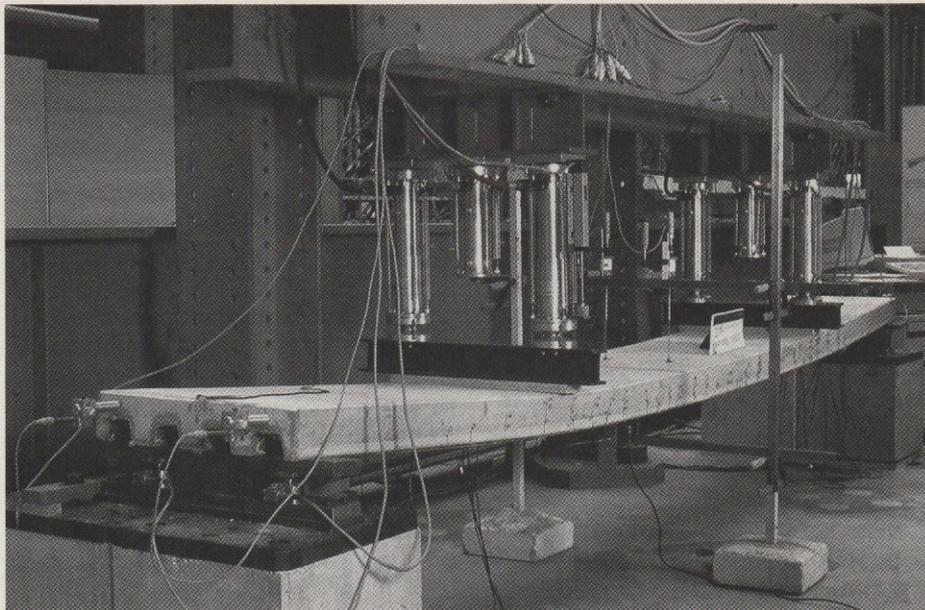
Essai de charge sur dalle mixte avec tôle profilée HI-Bond 55.
